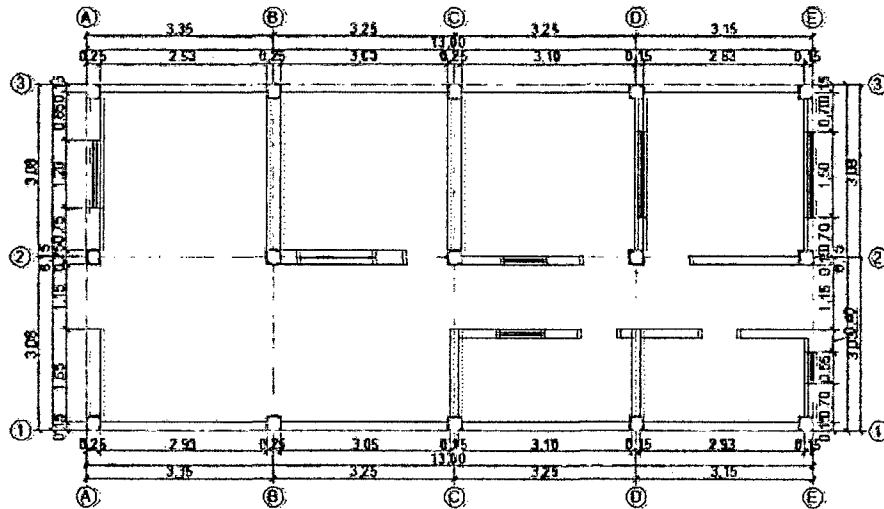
Plano de arquitectura de la planta típica de la Vivienda TV5.
